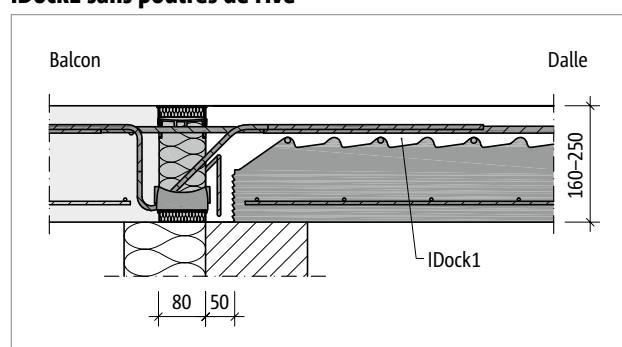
Schöck Isokorb® T Type K-E : Raccordement de balcons avec des épaisseurs de panneaux de 160 mm à 250 mm avec IDock1
